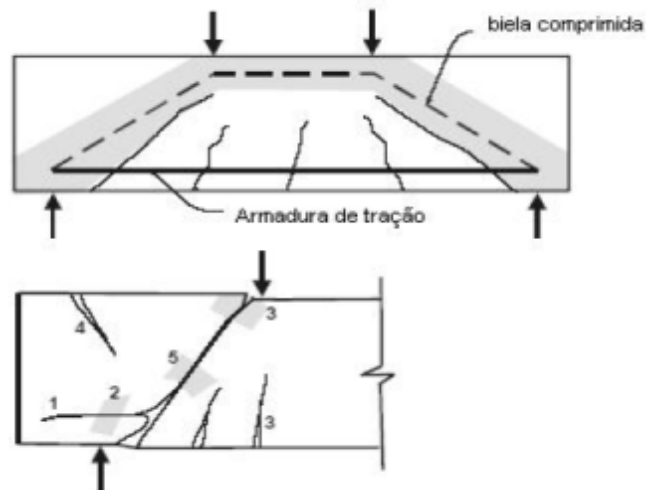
Modelos de ruptura em vigas curtas (vigas-paredes) (ACI-ASCE 426, 1973).
